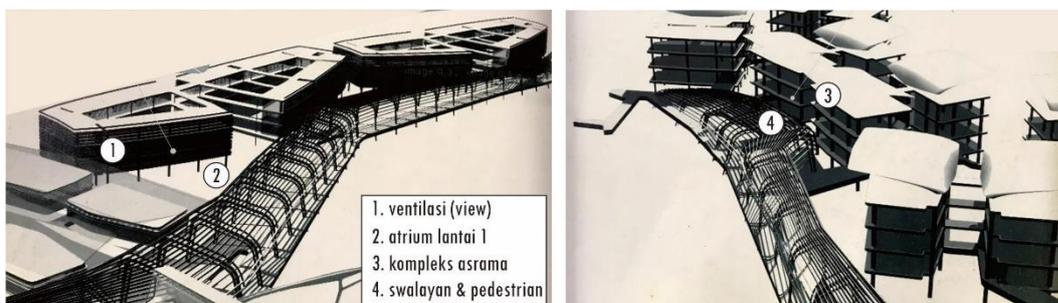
Ruang lantai bawah Tech-Linx dan selasar sebagai kontrol termal dalam bangunan dan pencahayaan alami pada fasad (Yeang, 2001)
